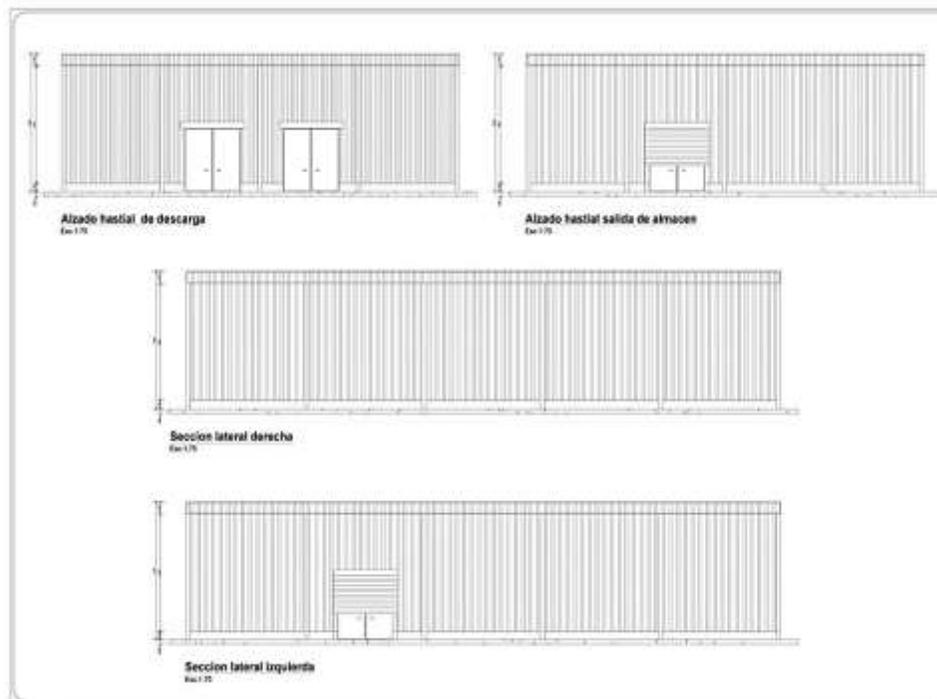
plano cerramiento paredes externas (Elaboración propia,2022)
